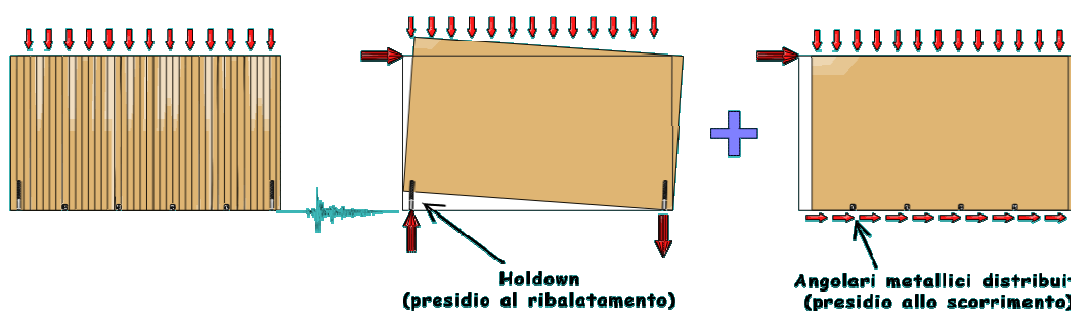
Effetti dell'azione sismica agente su una parete e diversa funzione degli elementi di collegamento.
